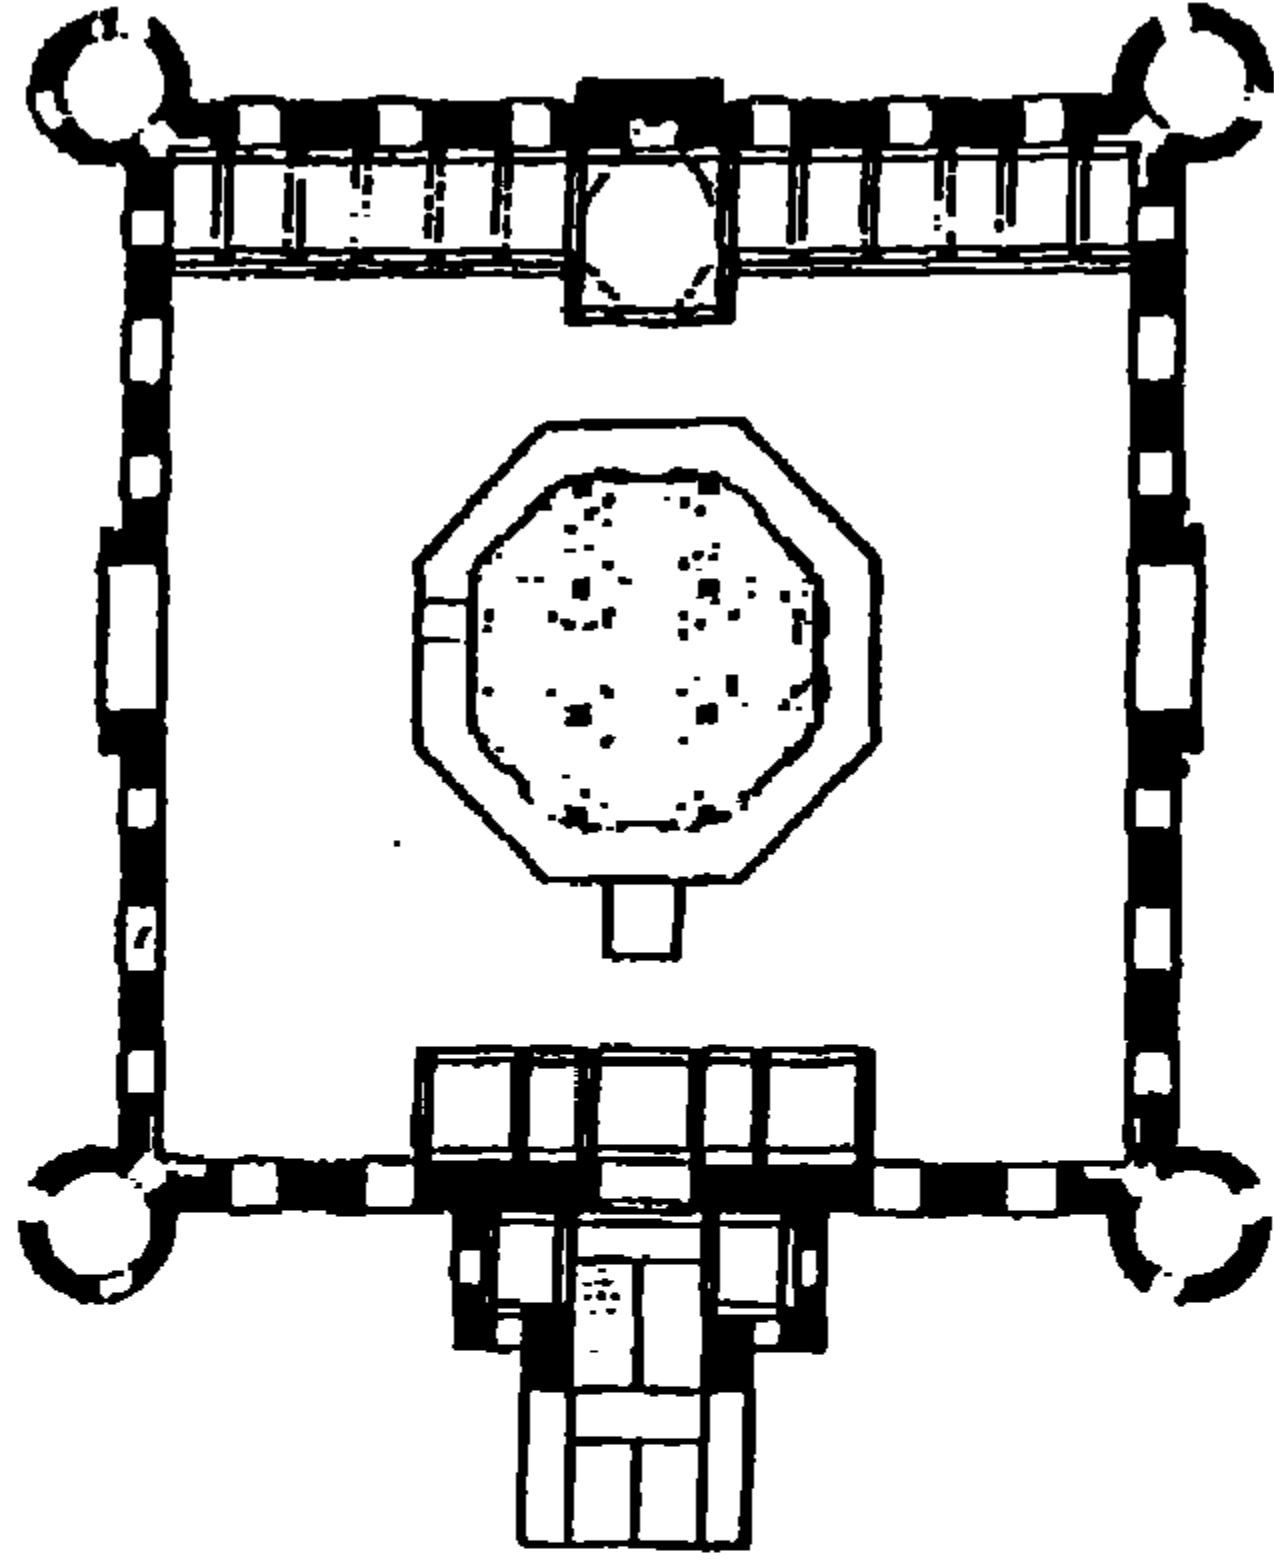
/١) مسقط أفقي لقصر هاشت بهشت (القرن ١٧)
